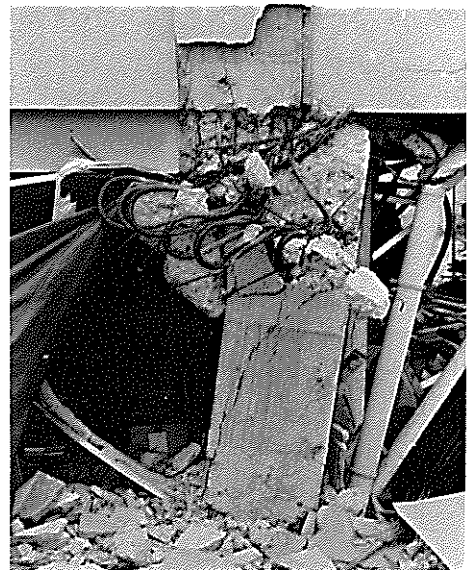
鉄筋コンクリート造3階建物の崩壊（Oビル）
